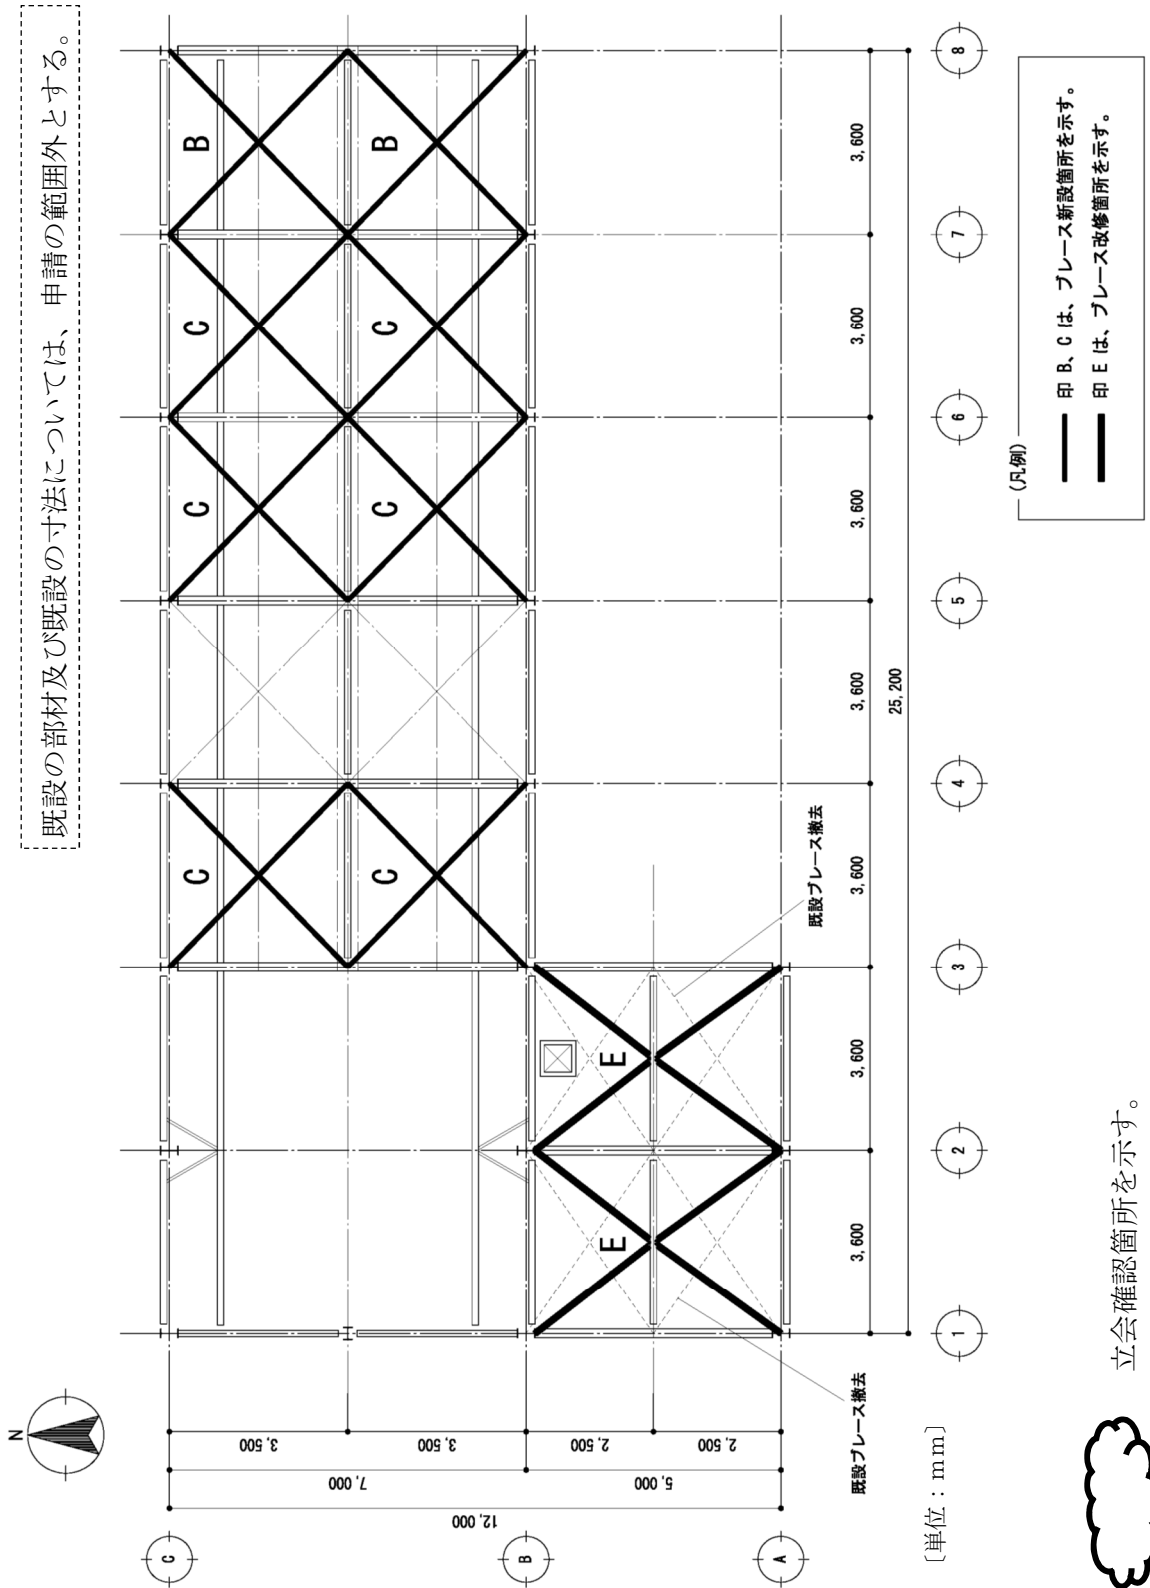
燃料棟 屋根伏図 (R2 レベル)
